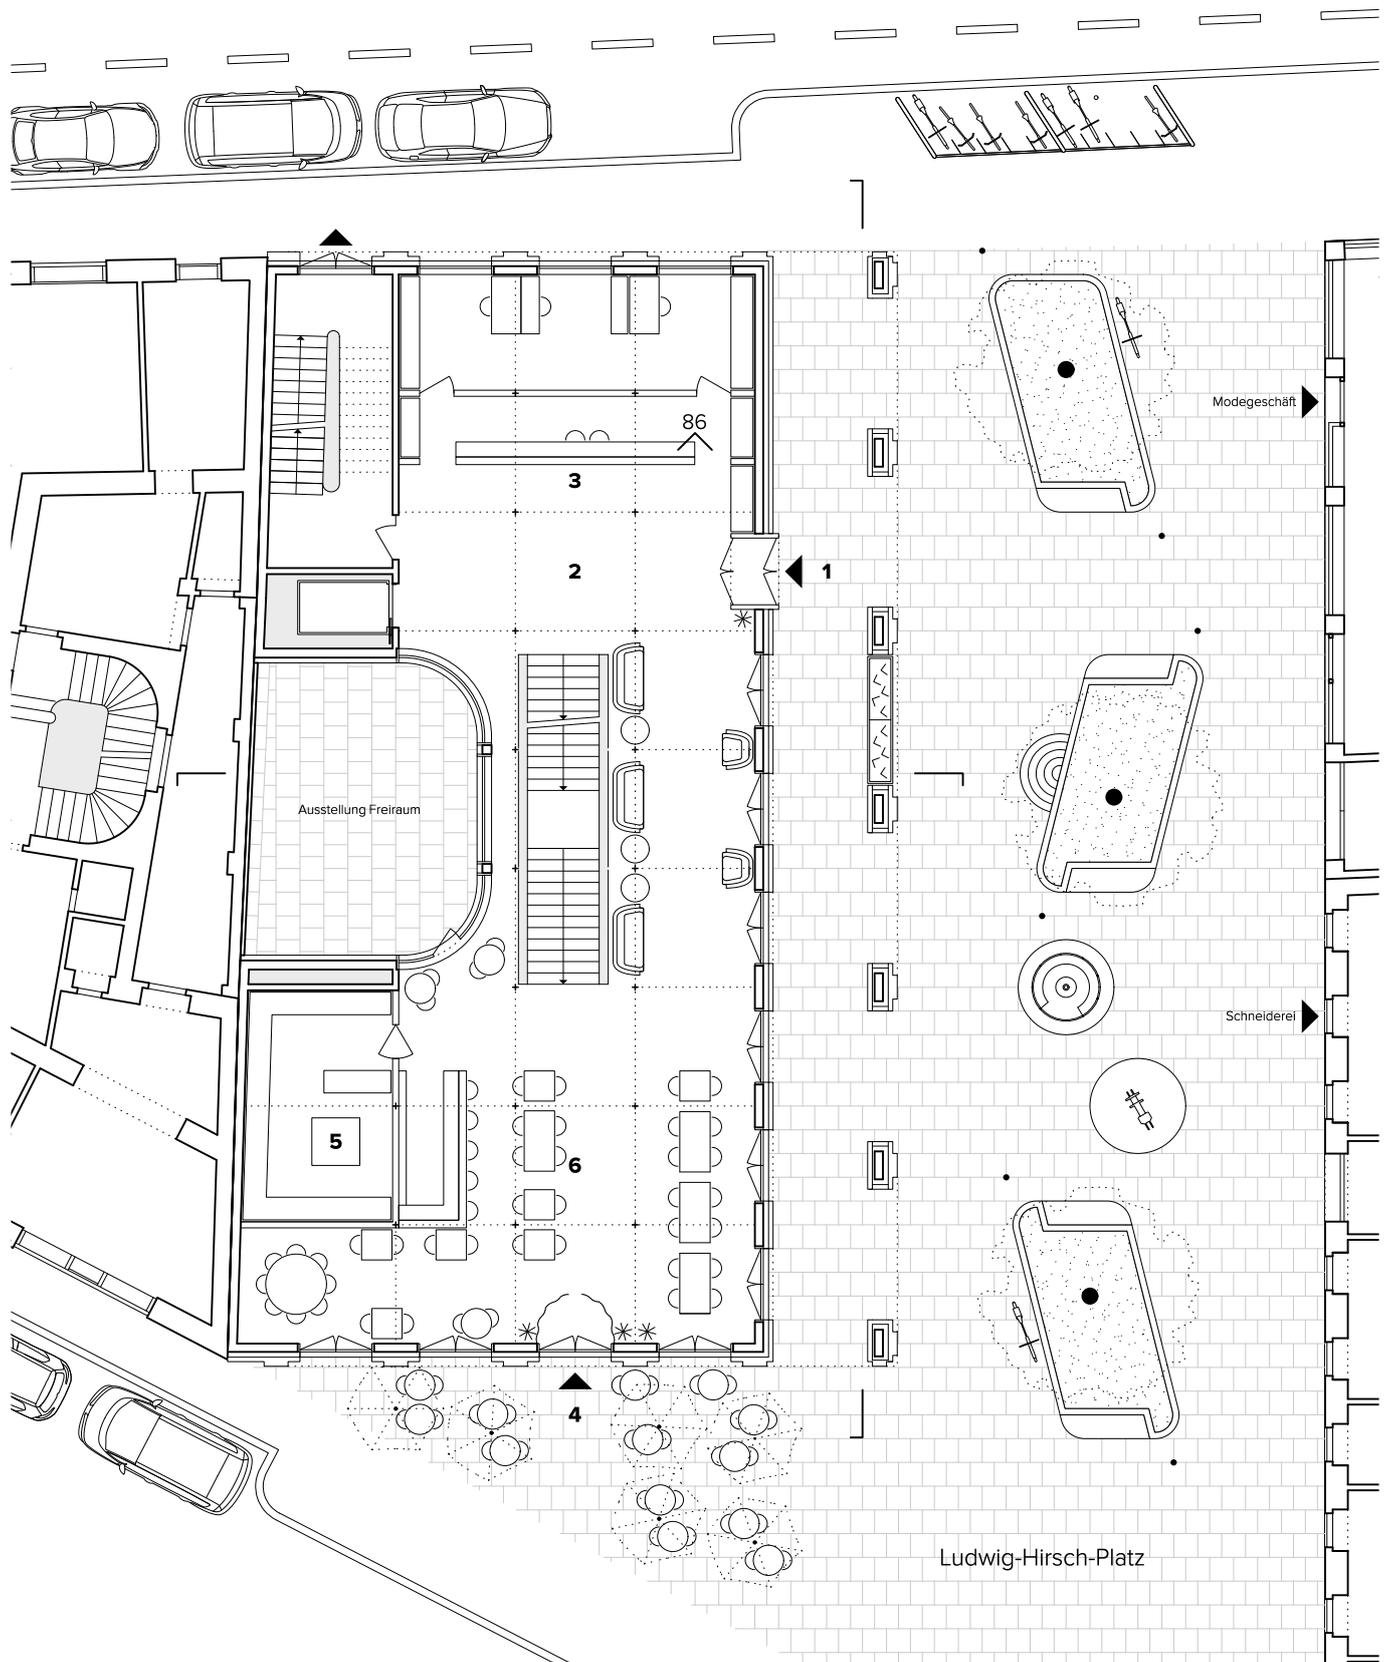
Grundriss Erdgeschoss 1.200 (BM) 1 Eingang Bibliothek 2 Foyer 3 Theke und Administration 4 Eingang Café 5 Küche 5 Tagescafé
